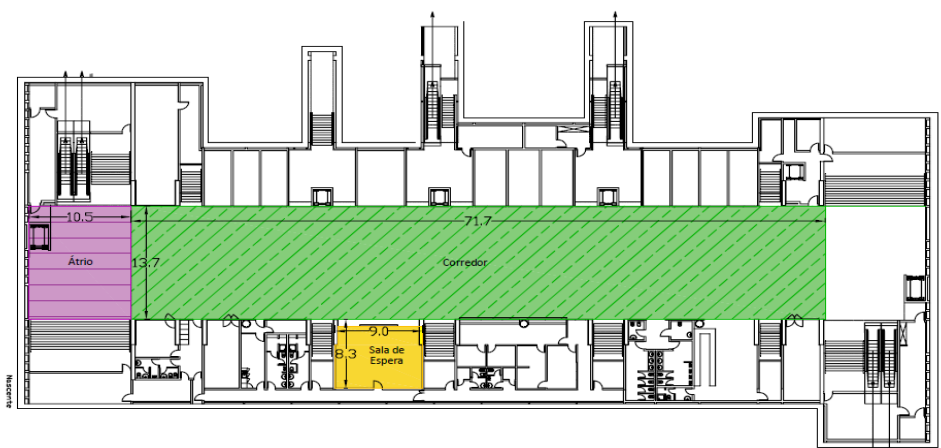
Planta esquemática do piso subterrâneo (dimensões em metros)
